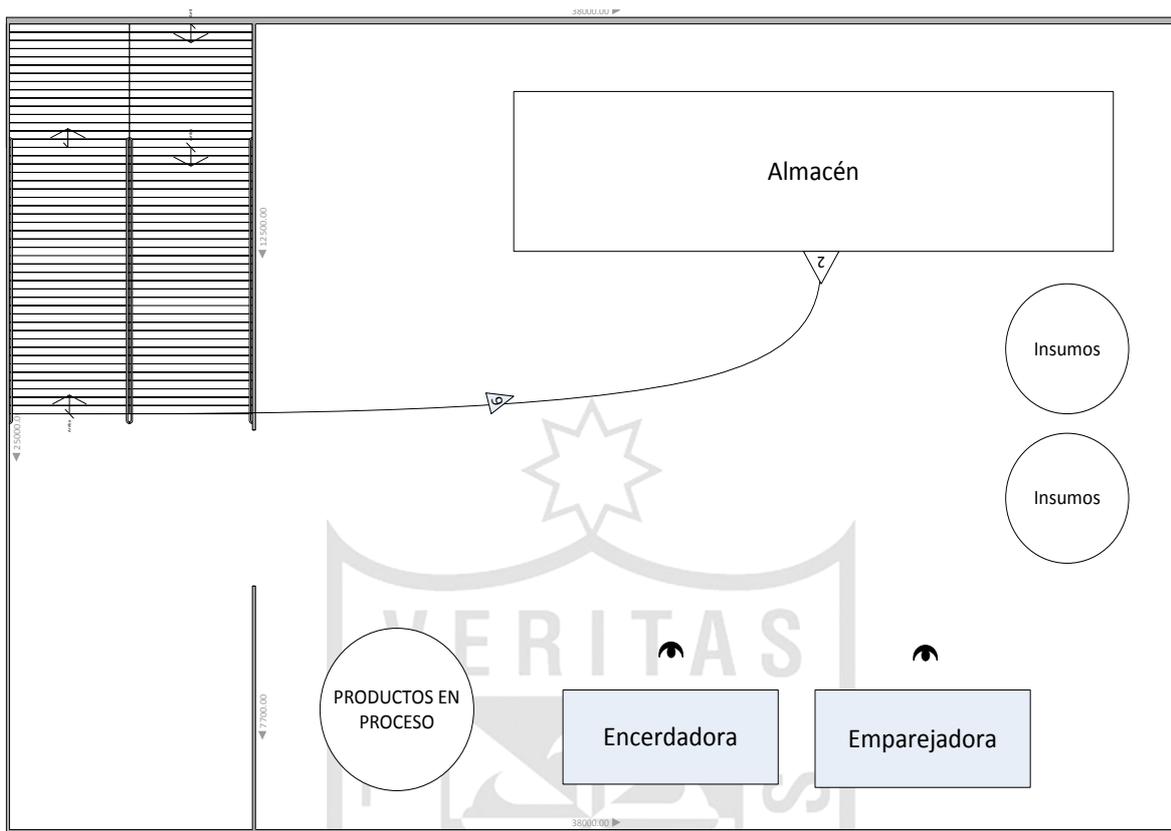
Plano: Vista de Planta del 3er piso de la empresa LEÓN PLAST con la nueva redistribución.
